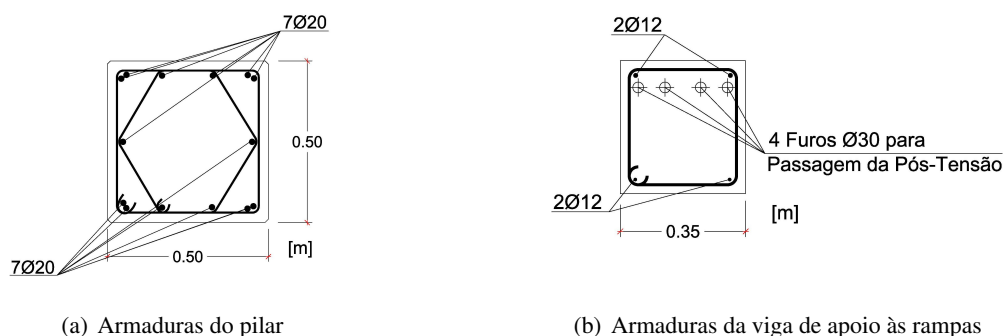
Peças de dimensionamento com as respectivas armaduras [18]
